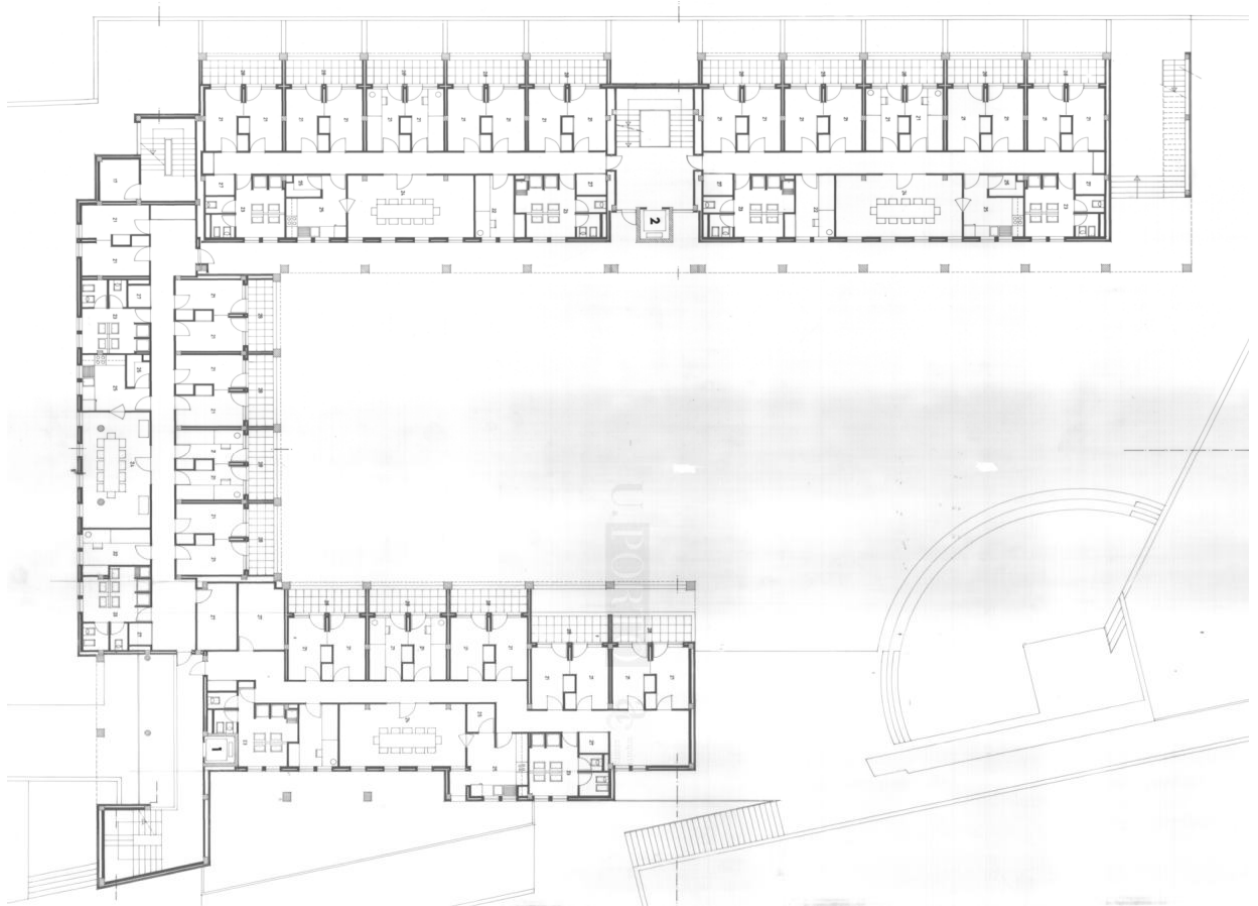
Planta Piso 5 (2º andar) da RUCA I.
